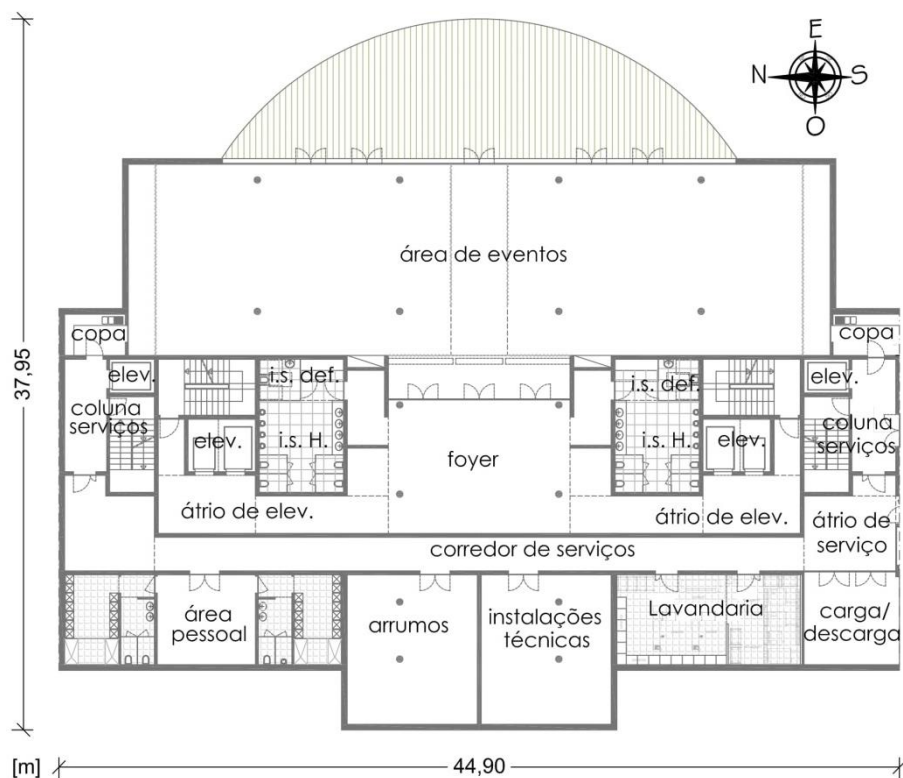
Planta Arquitetónica da Cave: corpo E (s/escala).
